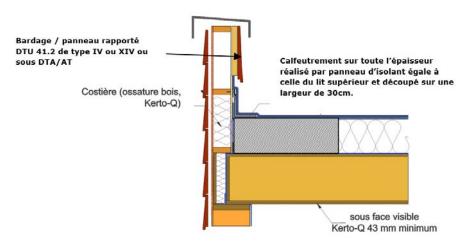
Exemple de calfeutrement au droit d'une traversée de toiture
